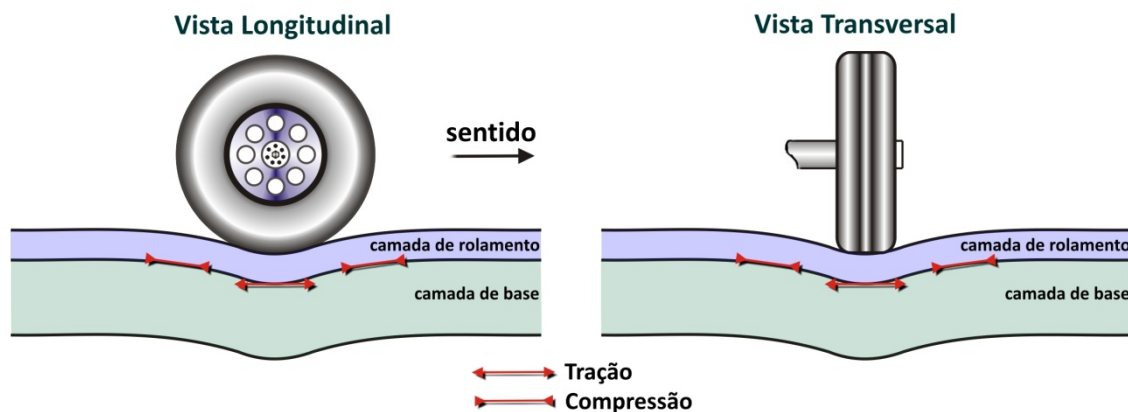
Deformações no pavimento pela passagem de uma carga em movimento.
